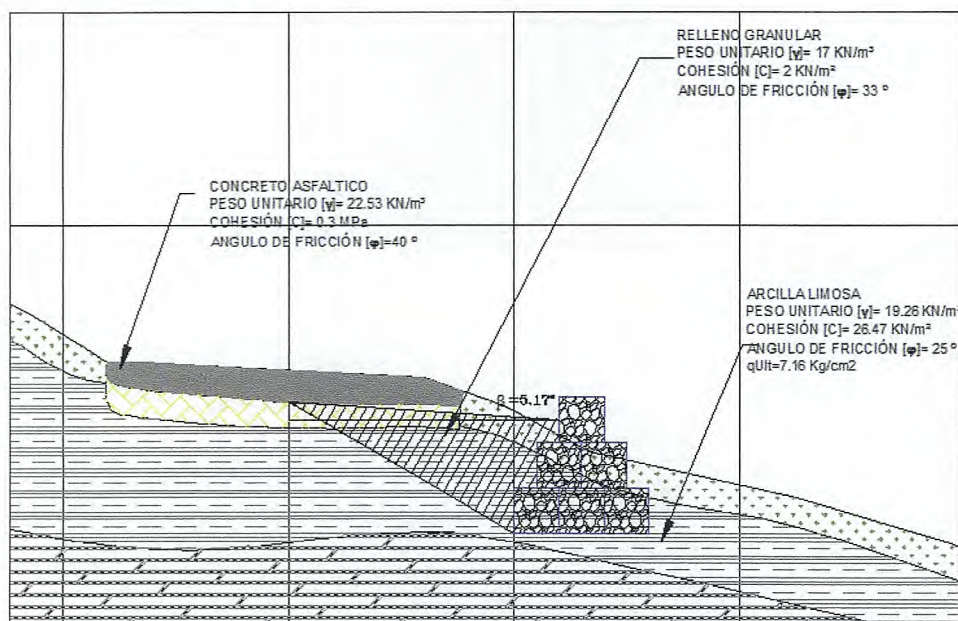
Esquema de Muro de Contención en Gavión SECCION 2, Perforaciones 1,2,3,4 y 5 Condición Largo Plazo
